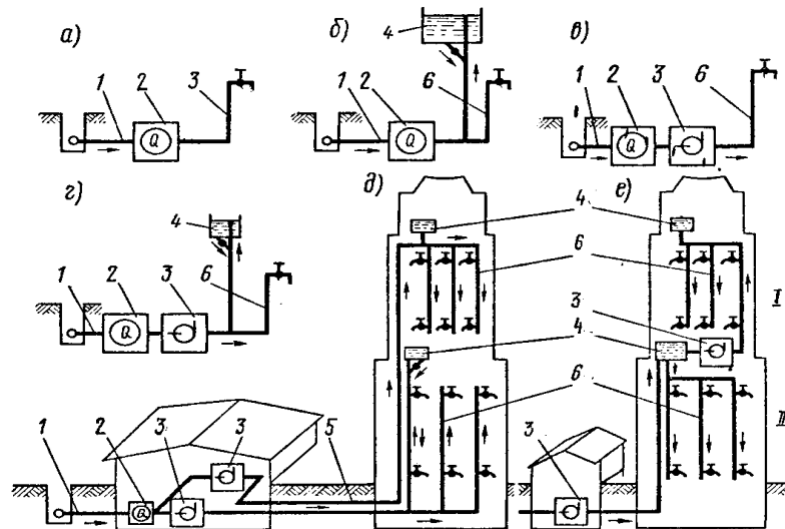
Схеми систем внутрішніх водопроводів:
